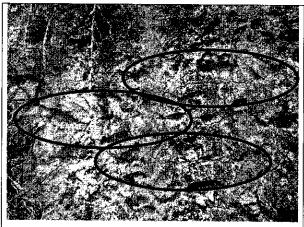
Agrietamiento diagonal escalonado siguiendo la pega entre unidades de mampostería.
